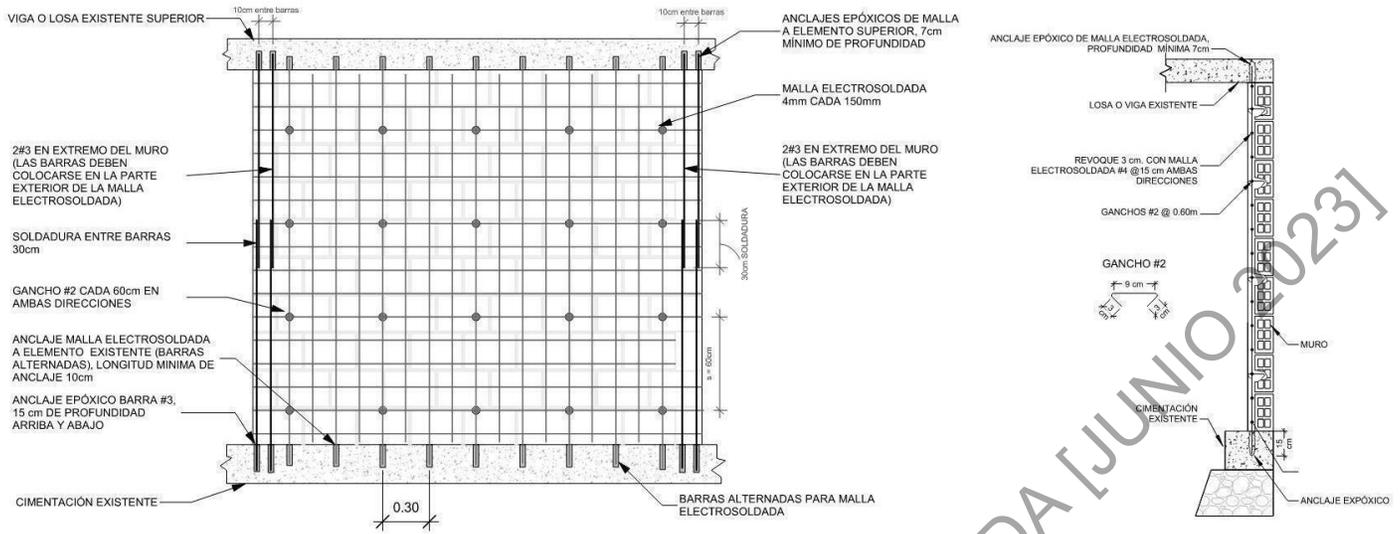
Conexión de muro nuevo a losa maciza existente.
